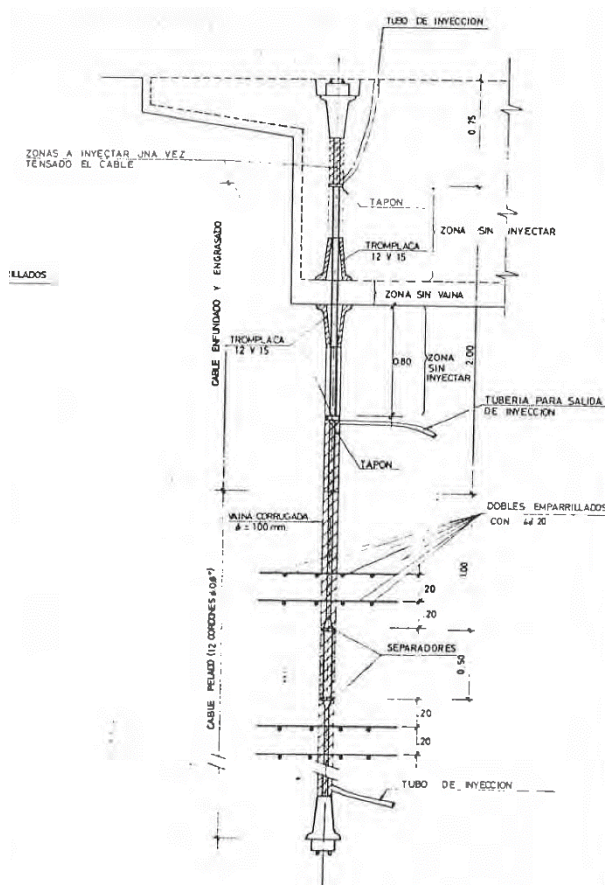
Detalle del sistema de anclaje vertical tablero-estribo en estructura de ampliación.
